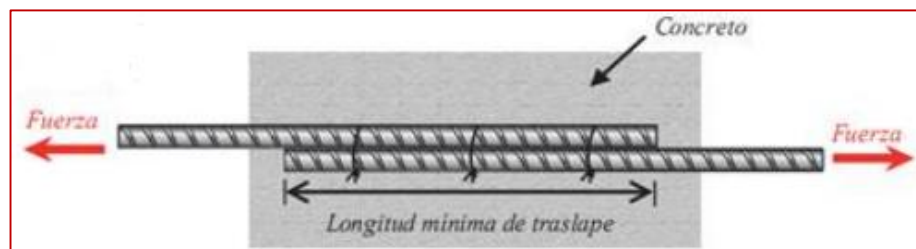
Zonas de Empalme por Traslape en Vigas
